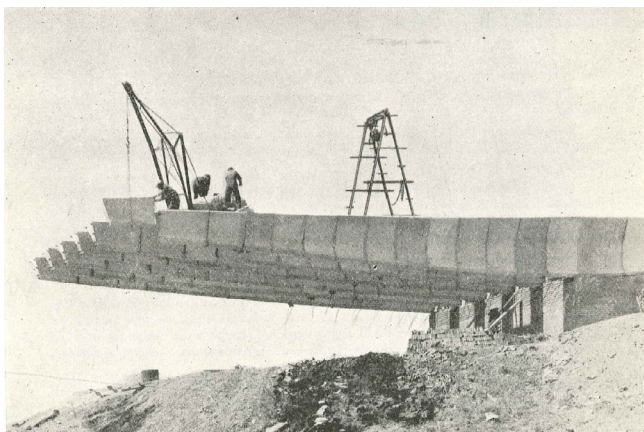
Construcción de la terraza de la casa Barredo. (33).
